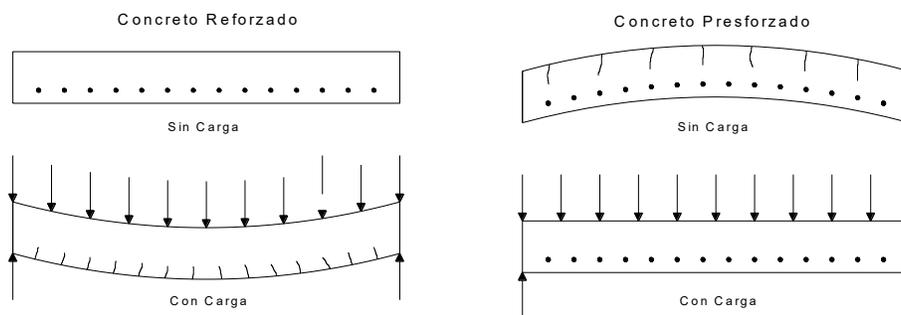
Comportamiento del concreto reforzado y presforzado.²⁰
